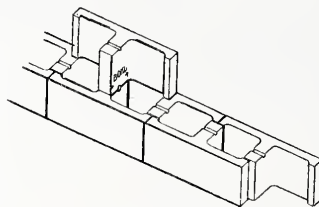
Betonsteine zur Herstellung hohler Maueru.
